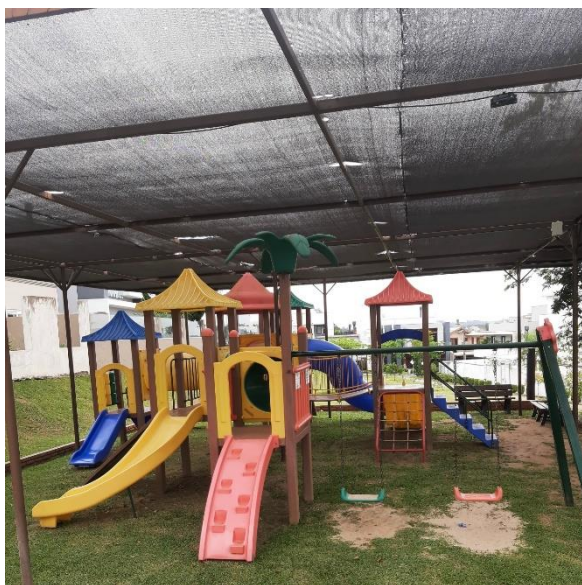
Vista do playground: destaque para a estrutura de cobertura.
